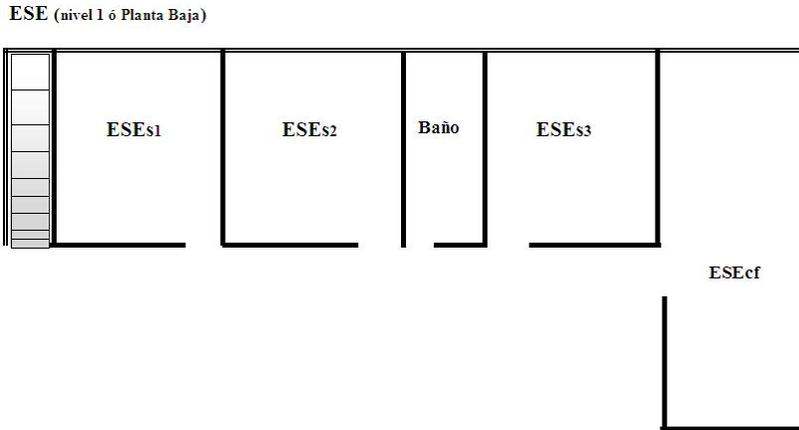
Esquema del Edificio de Secundaria. Nivel 1 ó Planta Baja.
